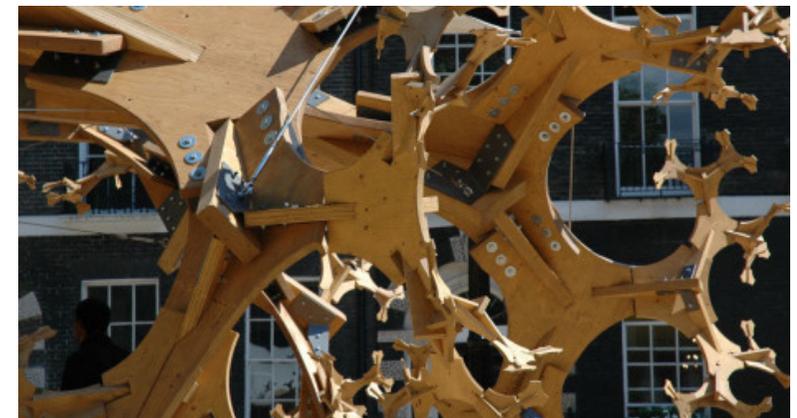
Dettaglio costruttivo Fractal Pavilion, AA Summer Pavilion 2006, Londra (a destra);
